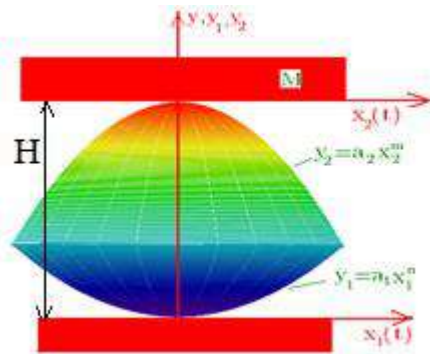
Схема опоры качения с опорными поверхностями высокого порядка
